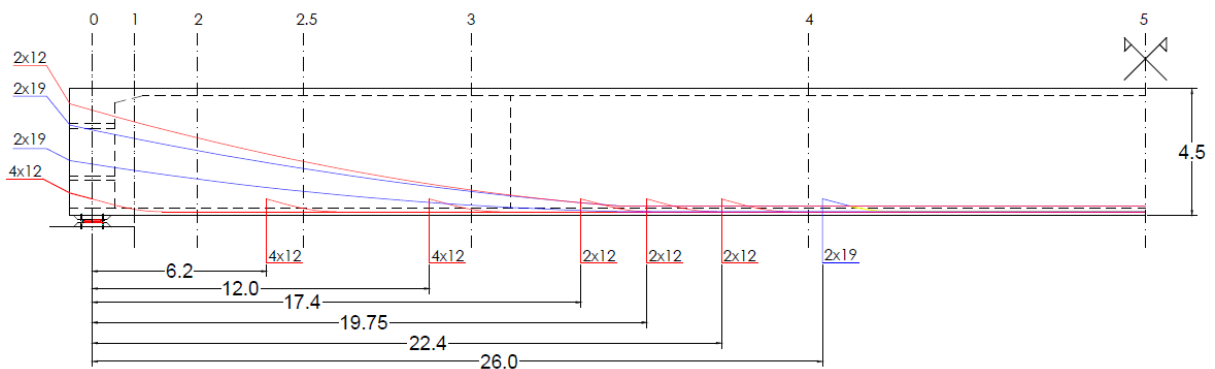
Traçado de pré-esforço [h=4.5m]
